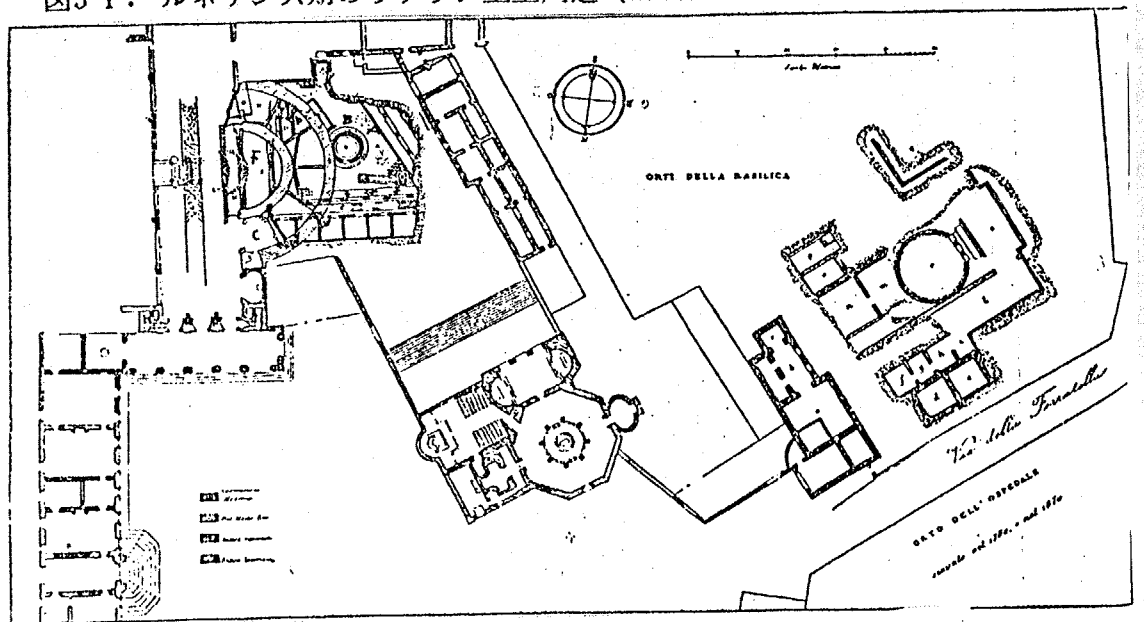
： ラテラン聖堂・洗礼堂平面図 (after R. Krautheimer et.al.)
